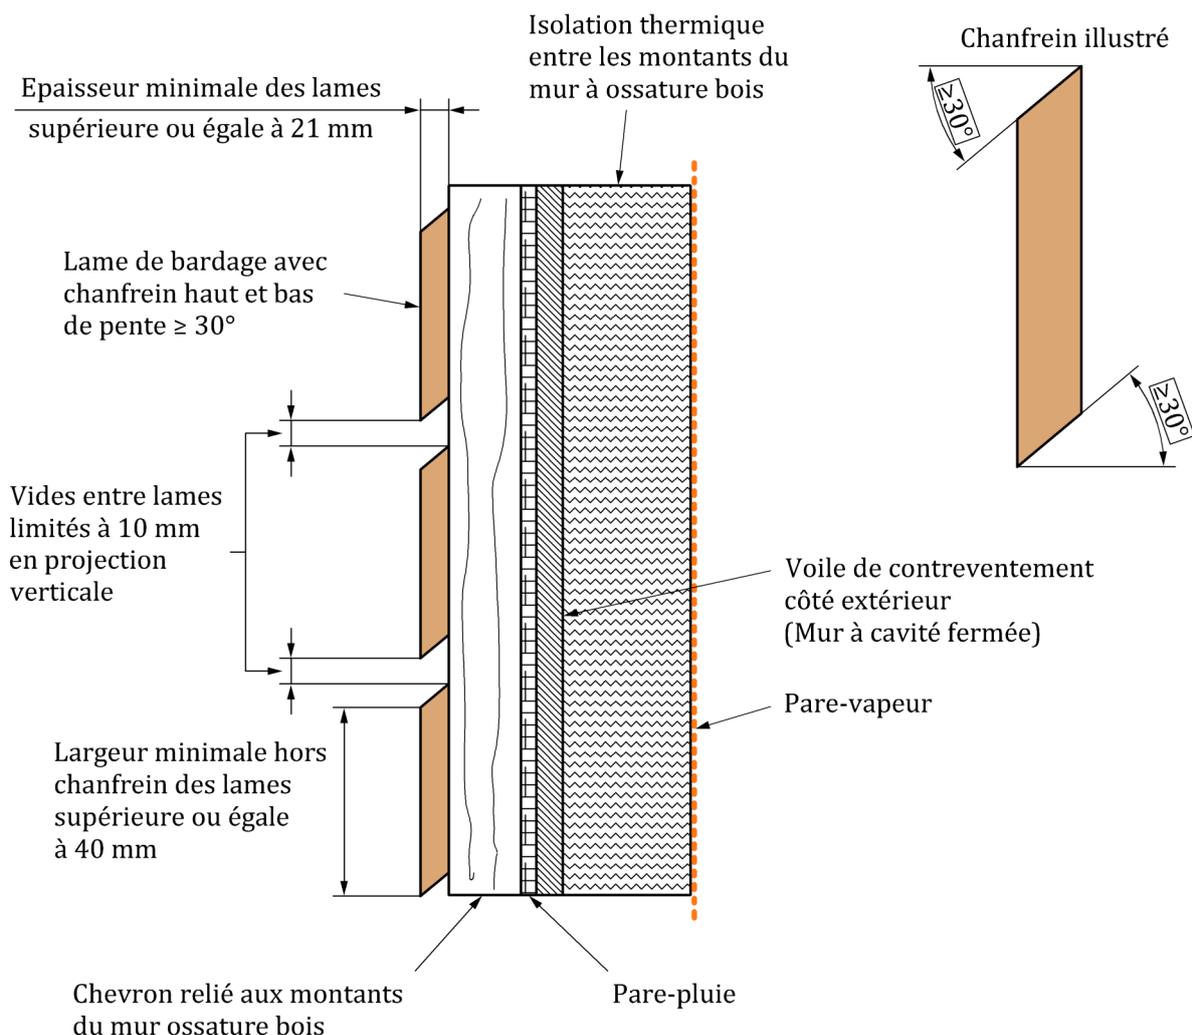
Bardage horizontal posé sur mur à ossature bois - coupe verticale
